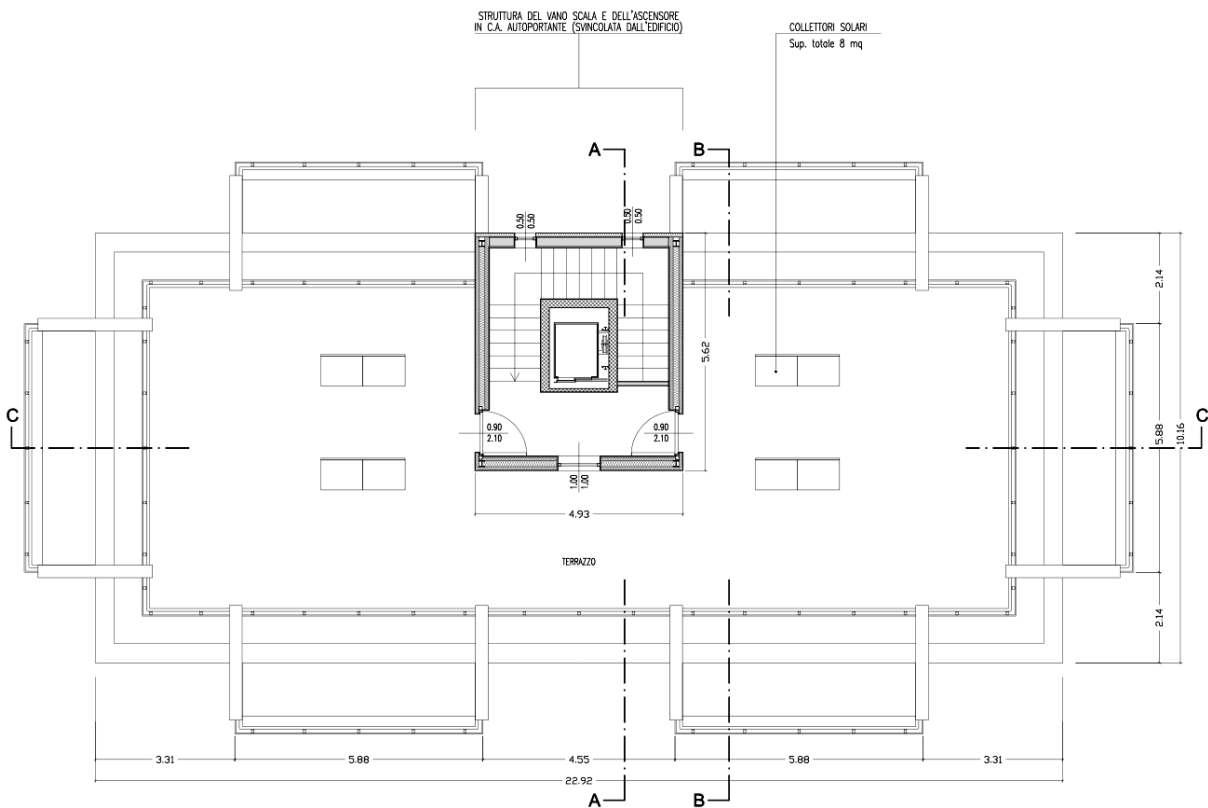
Palazzina: pianta terrazzo- archivio personale
